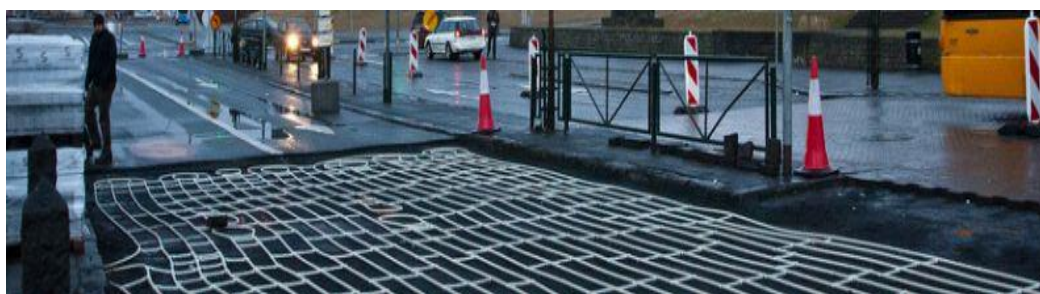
Aquecimento do pavimento numa rua em Reiquejavique, Islândia
